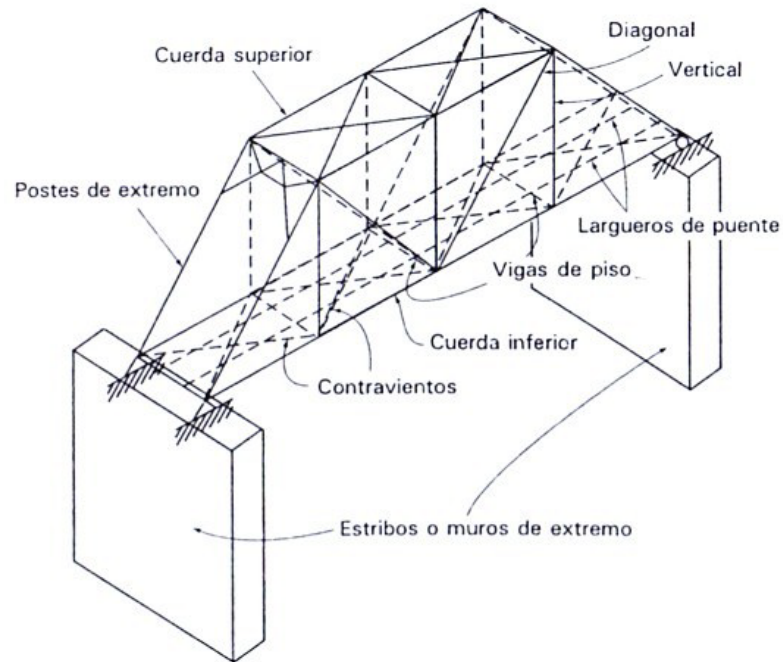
Componentes de una armadura de puente tipo Pratt.
